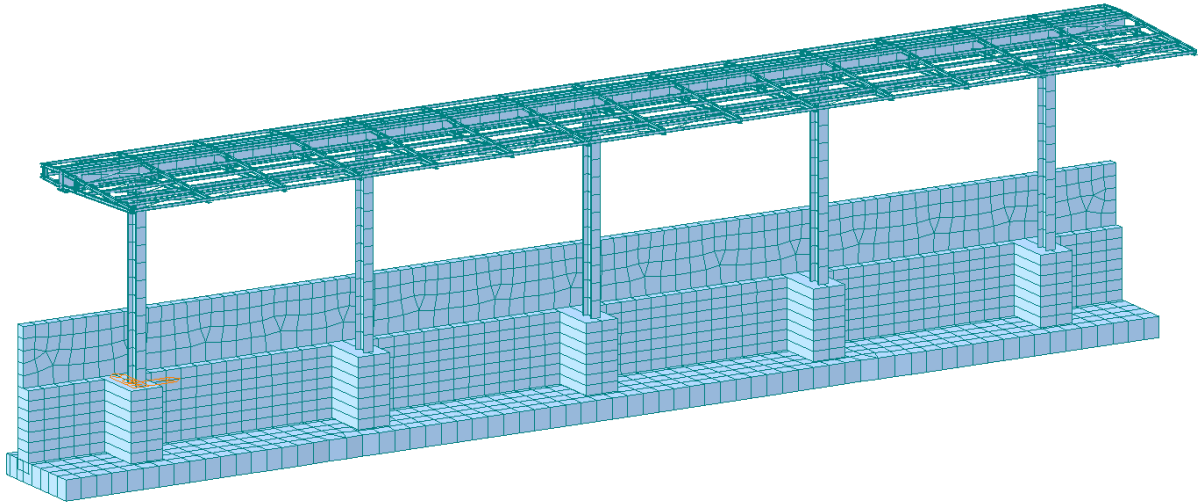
Rendering strutturale pensilina su muro tipo 2 – FV01
